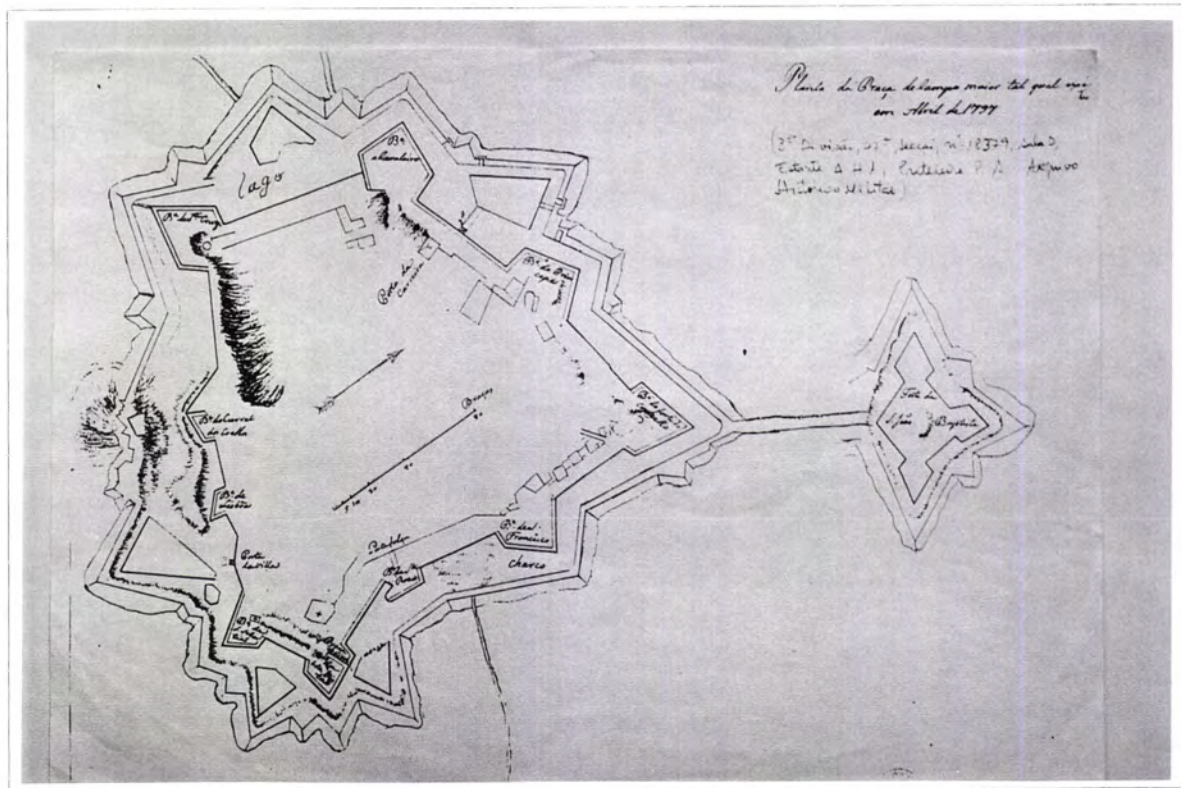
Castelo de Campo Maior. Planta de 1797.
